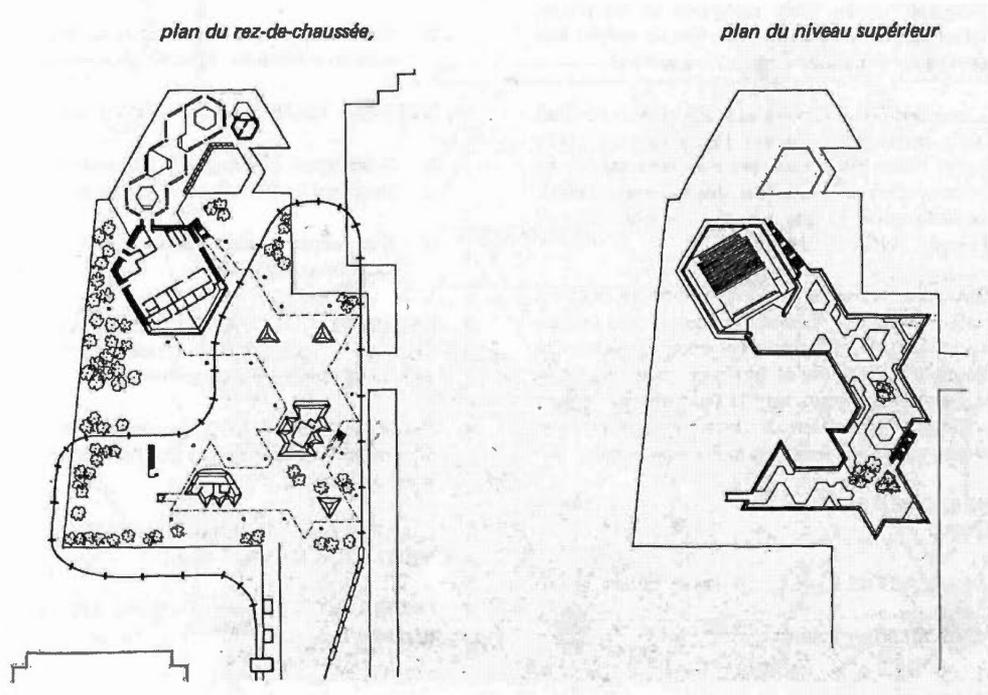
Plans du rez-de-chaussée et du niveau supérieur
